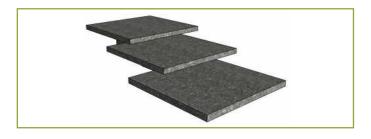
Schéma d'un escalier en dalles palières (Dessin de Cédric Houel)
